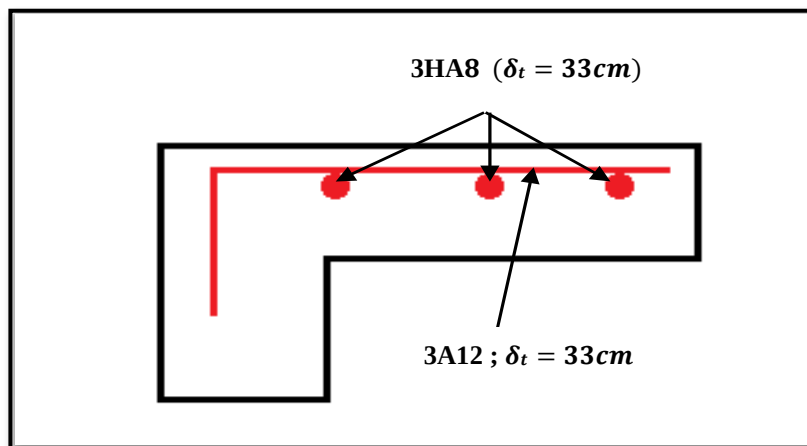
Schéma de ferrailage du balcon Type 1.
